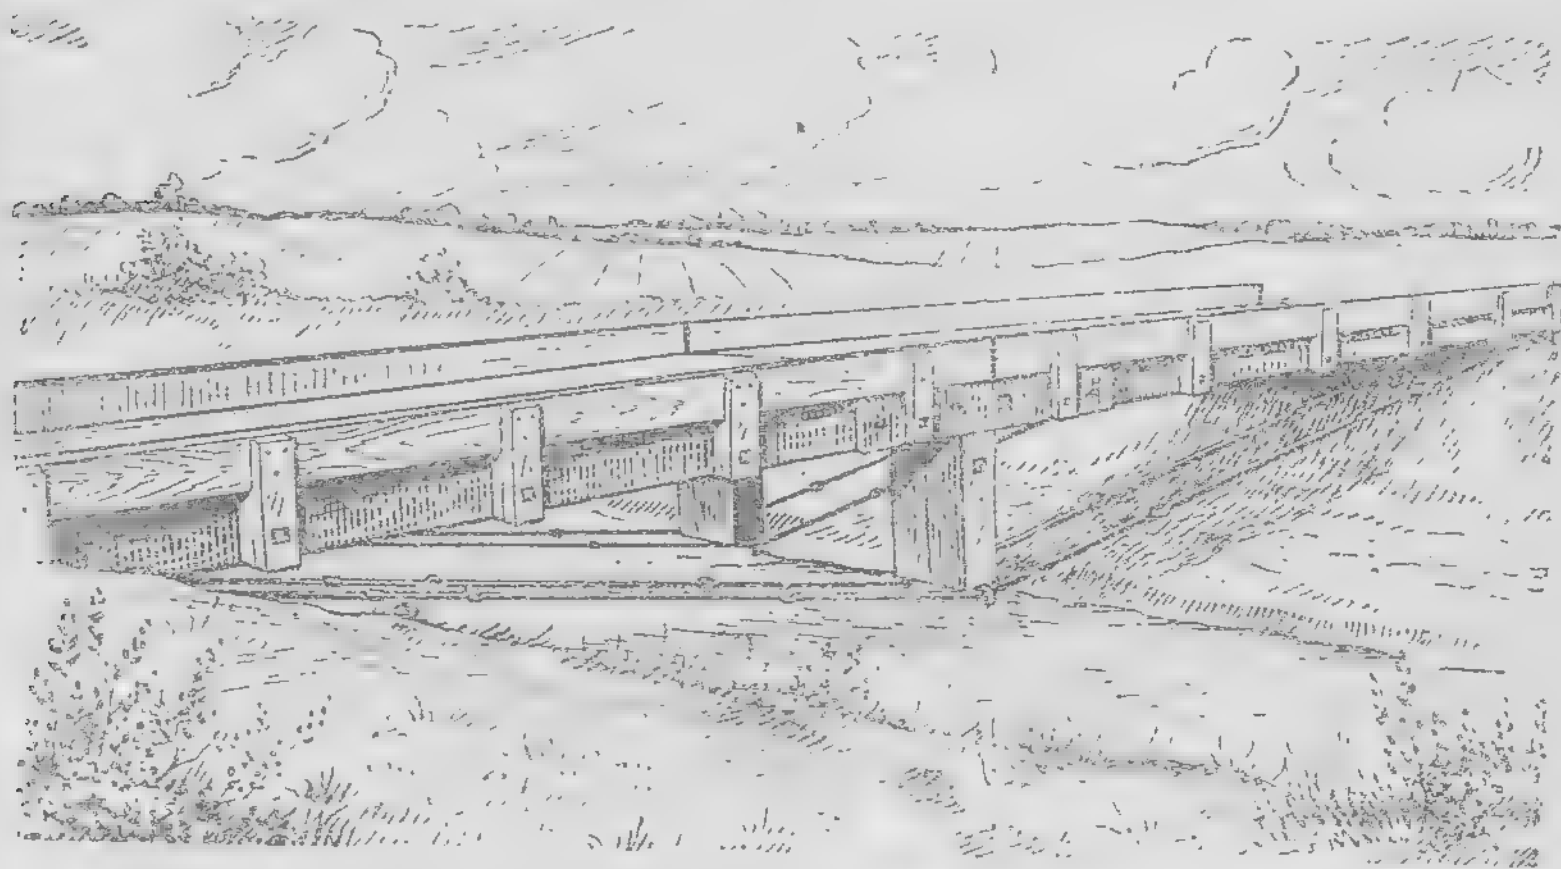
Общий вид шпренгельного моста с тяжами из круглого железа.
